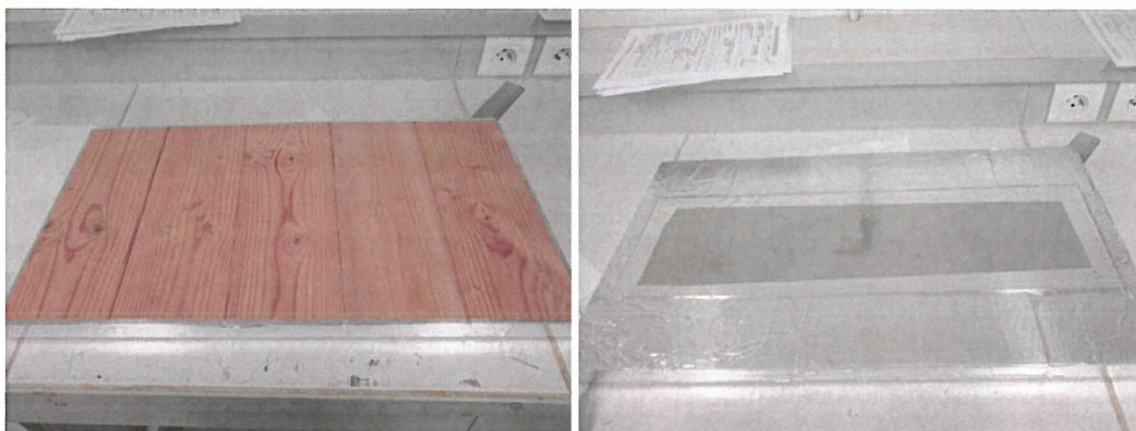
Epreuve d'essai 14/1216C/1 après découpe et colmatage
